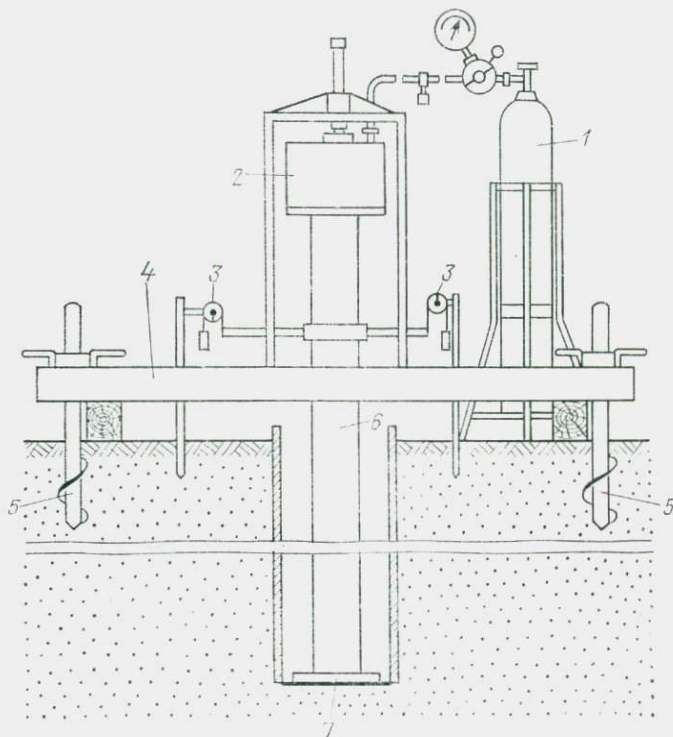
Схема установки УДГШ-600 для штамповых испытаний в скважинах: 1 — баллон со сжатым воздухом; 2 — пневматический домкрат; 3 — прогибомеры; 4 — упорная балка; 5 — анкеры; 6 — несущая колонна труб; 7 — штамп
